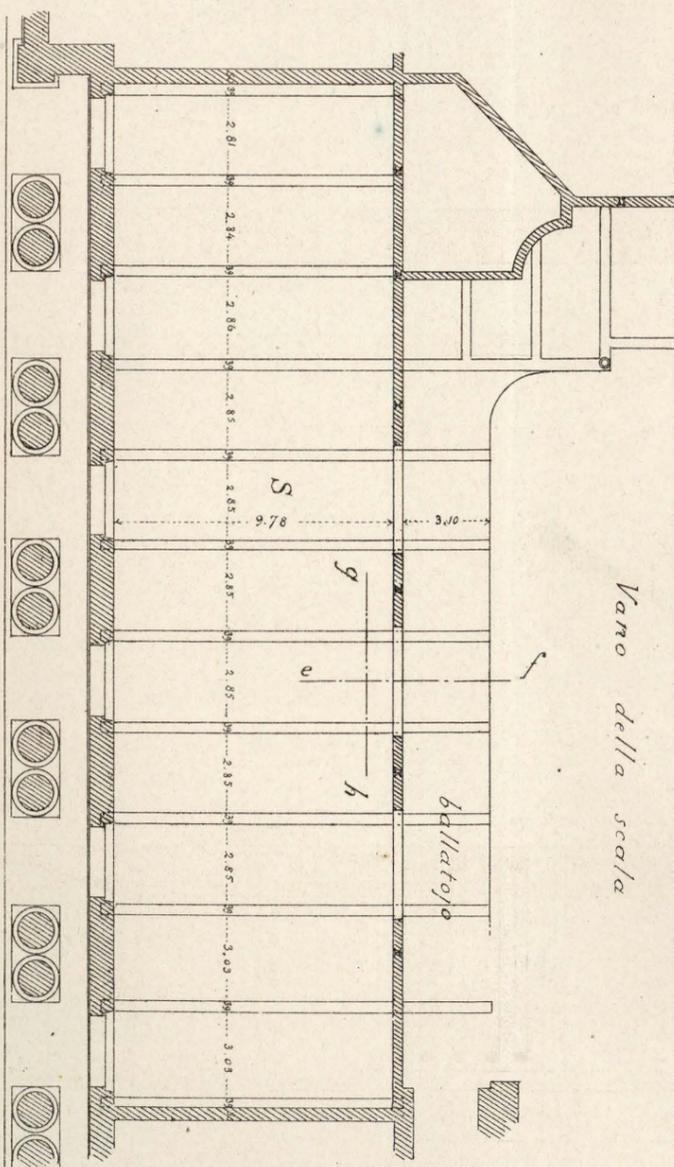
Solaio del salone ellittico: sezione secondo a b.
